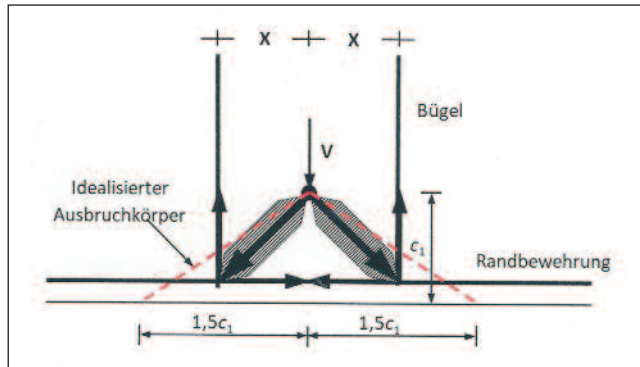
Befestigung mit einem Einzelbolzen am Bauteilrand mit Rückhängebewehrung, belastet durch eine Querlast zum Rand, und Fachwerkmodell, entnommen [23]
